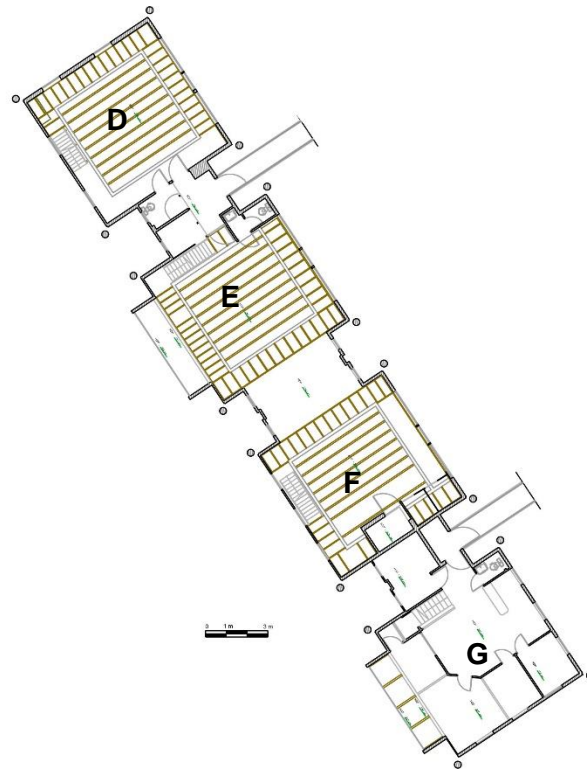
niveau rez-de-chaussée surélevé – état existant
